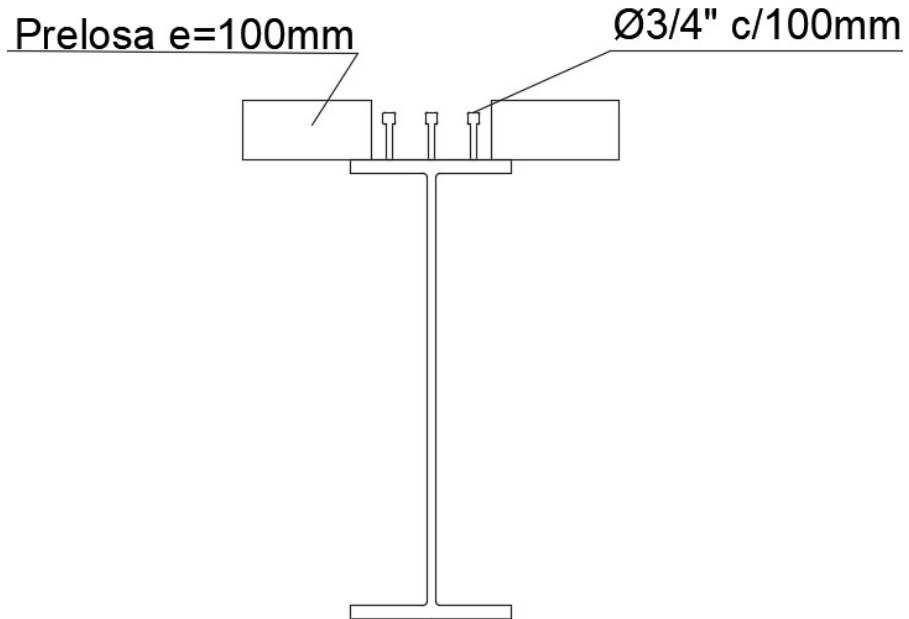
Detalle de la unión entre la viga longitudinal central y la losa del tablero.
